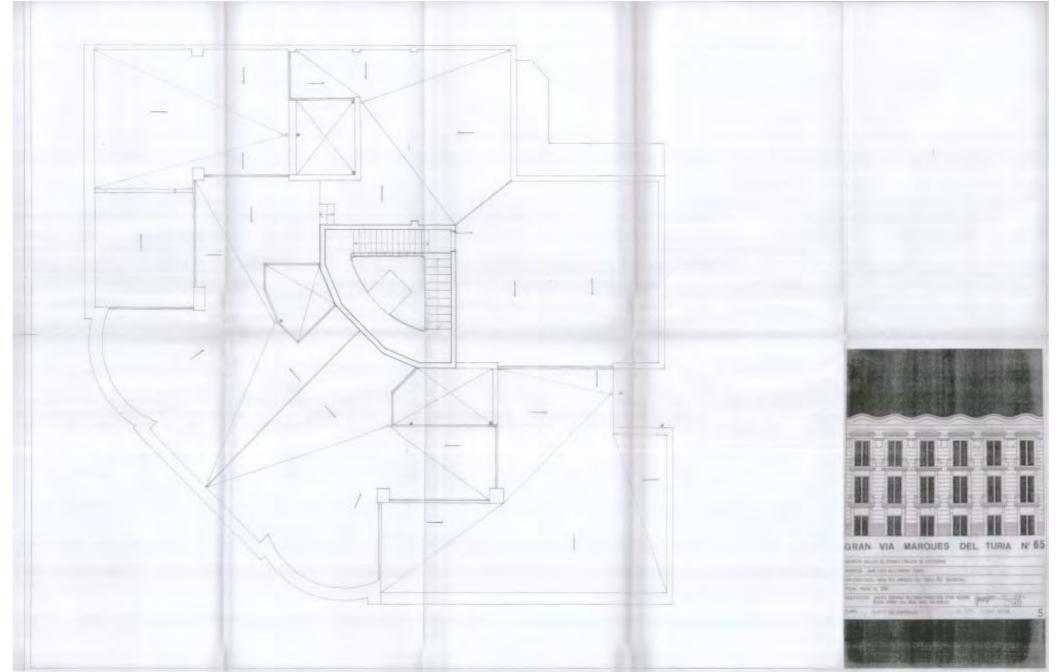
Planta cubiertas estado actual proyecto de rehabilitación 1985
